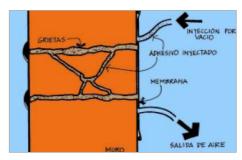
Pared Reparada por inyección de grietas Fuente: Investigación
